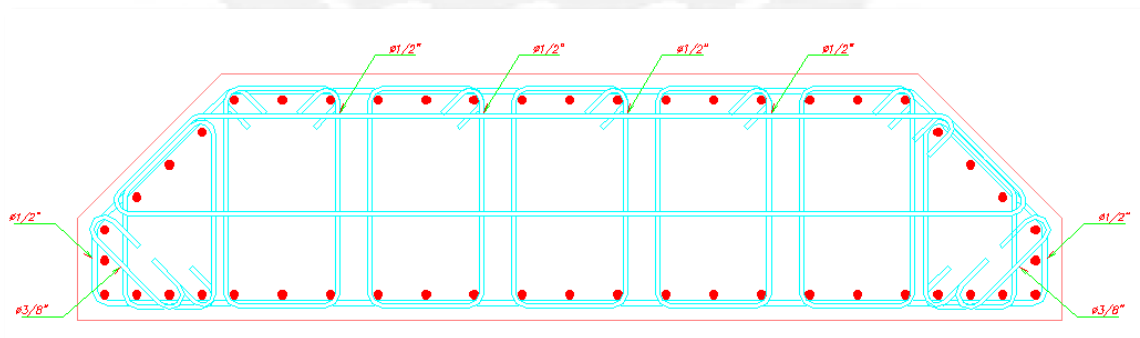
Pilares extremos con 48φ1" y 9 estribos 1/2" + 2 ganchos de 3/8".
